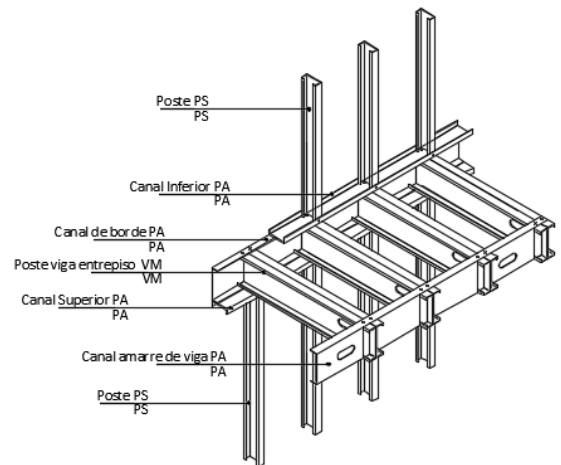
, Elementos de un entrepiso. (Fuente: propia del autor)
